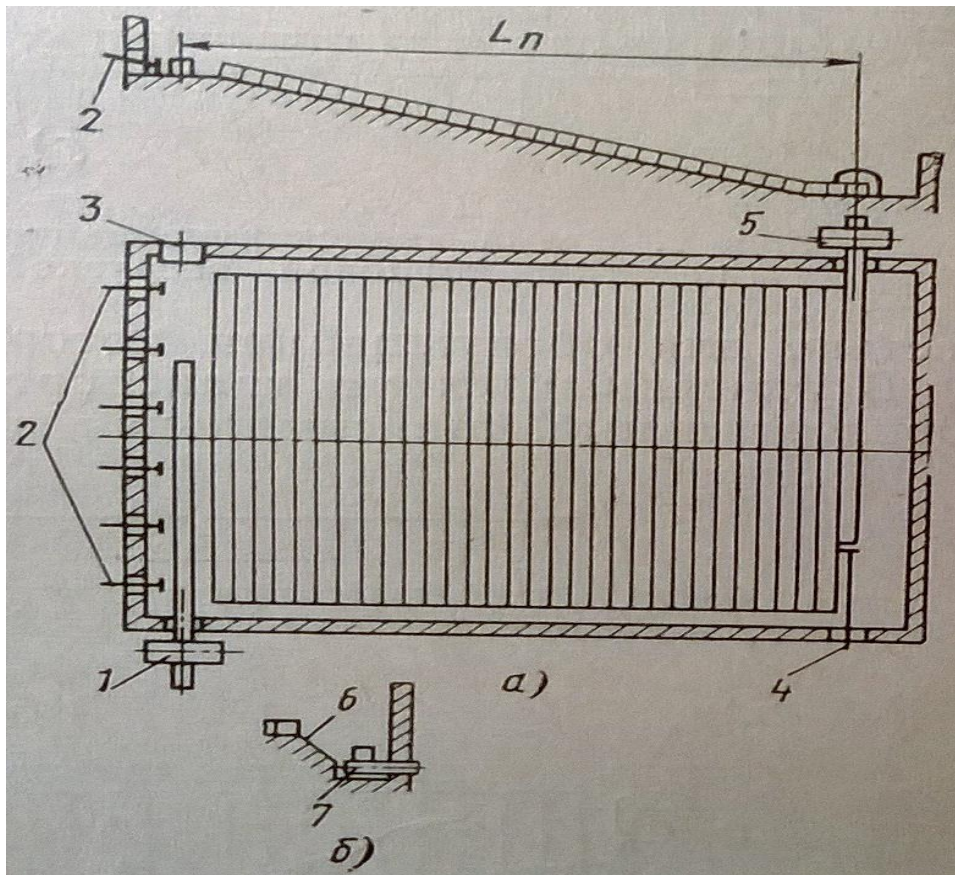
Схема транспортирования с боковой загрузкой и боковой выдачей
